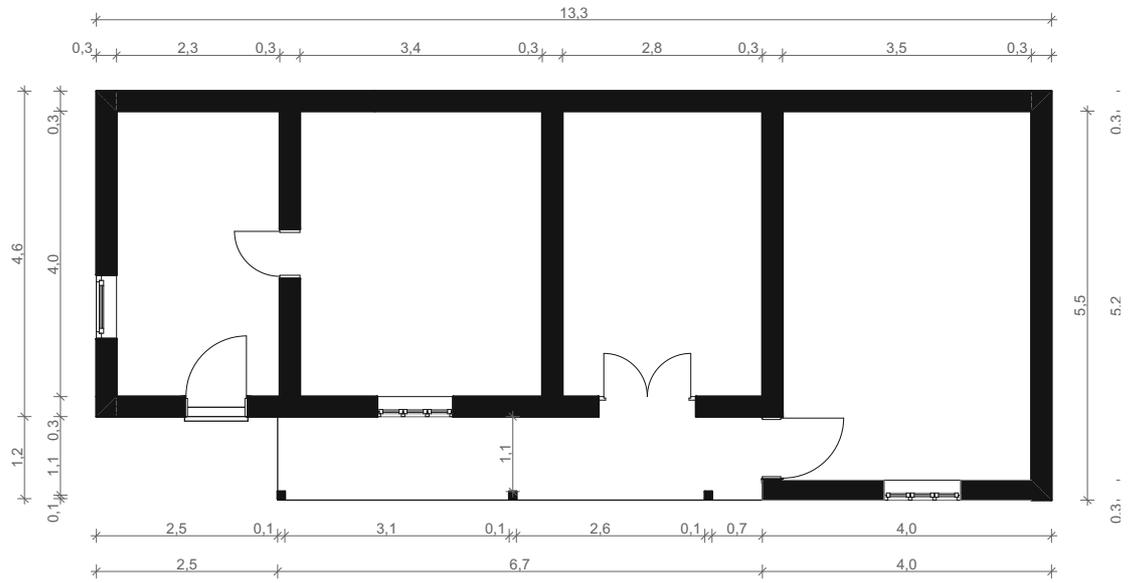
Pläne Haus Foltesti (Grundriss, Ansicht)
